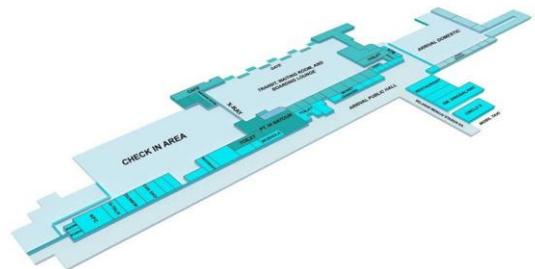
Denah lantai 3 Bandar Udara Adi Soemarmo
